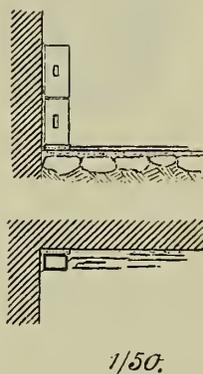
Auf- und Grundriss der Nordostecke des Raumes 9 der Bäder mit in situ befindlichen Heizröhren.
